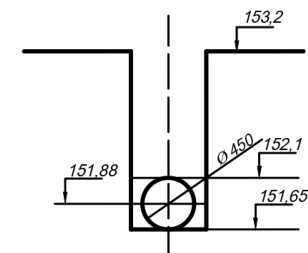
Поздовжні профілі та поперечні перерізи трубопроводів КР1-КР2
